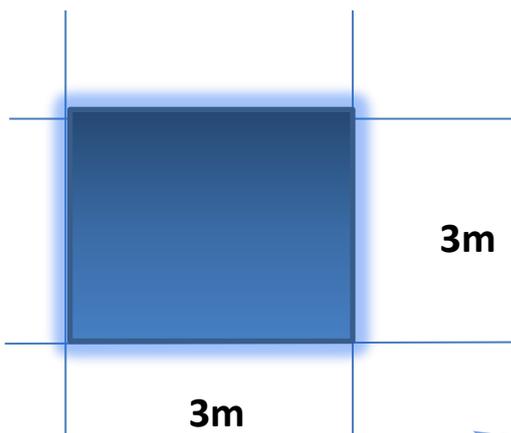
plan de groupement type -A -d'exemplaire de projet
